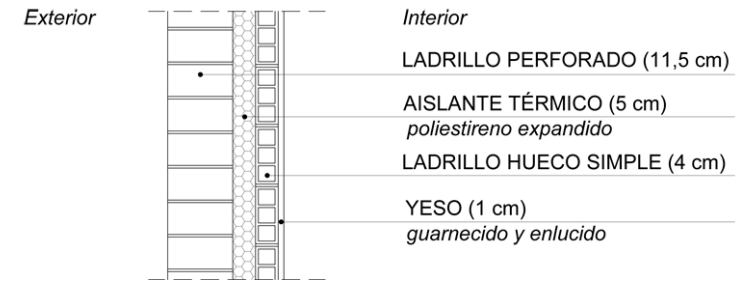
Detalle constructivo de las fachadas del modelo convencional.
